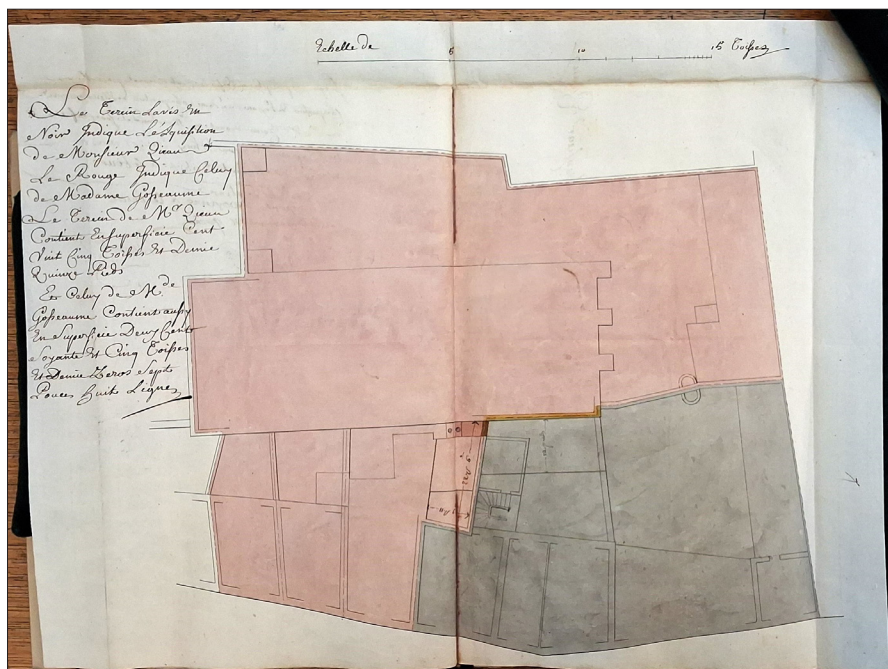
Plan de la partie vendue à M. Queau (en gris) joint à la vente du 13 août 1763. Plan : Archives nationales, MC/ET/CXIX/369 (photographie E. Cavanna).
